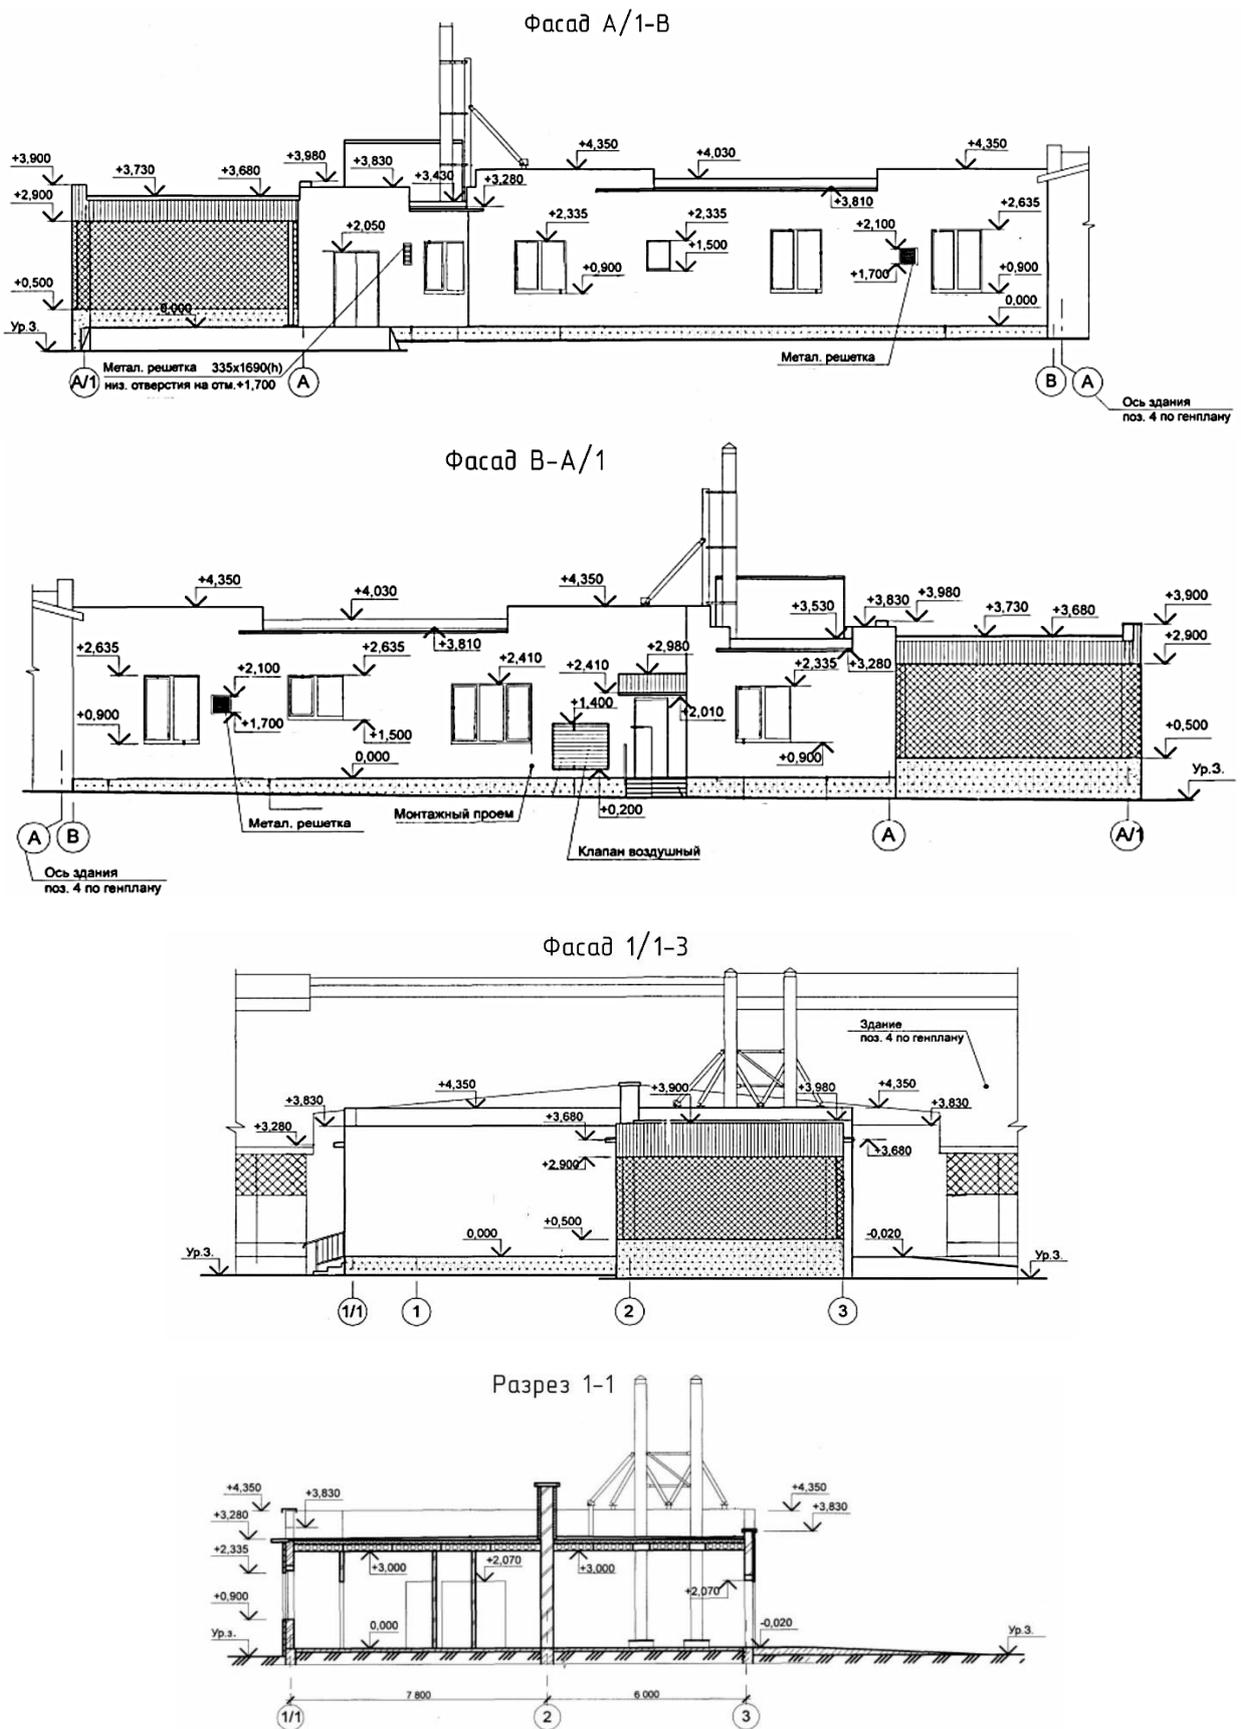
Фасады и разрез доильно-молочного блока с установкой УДМ-8БП
